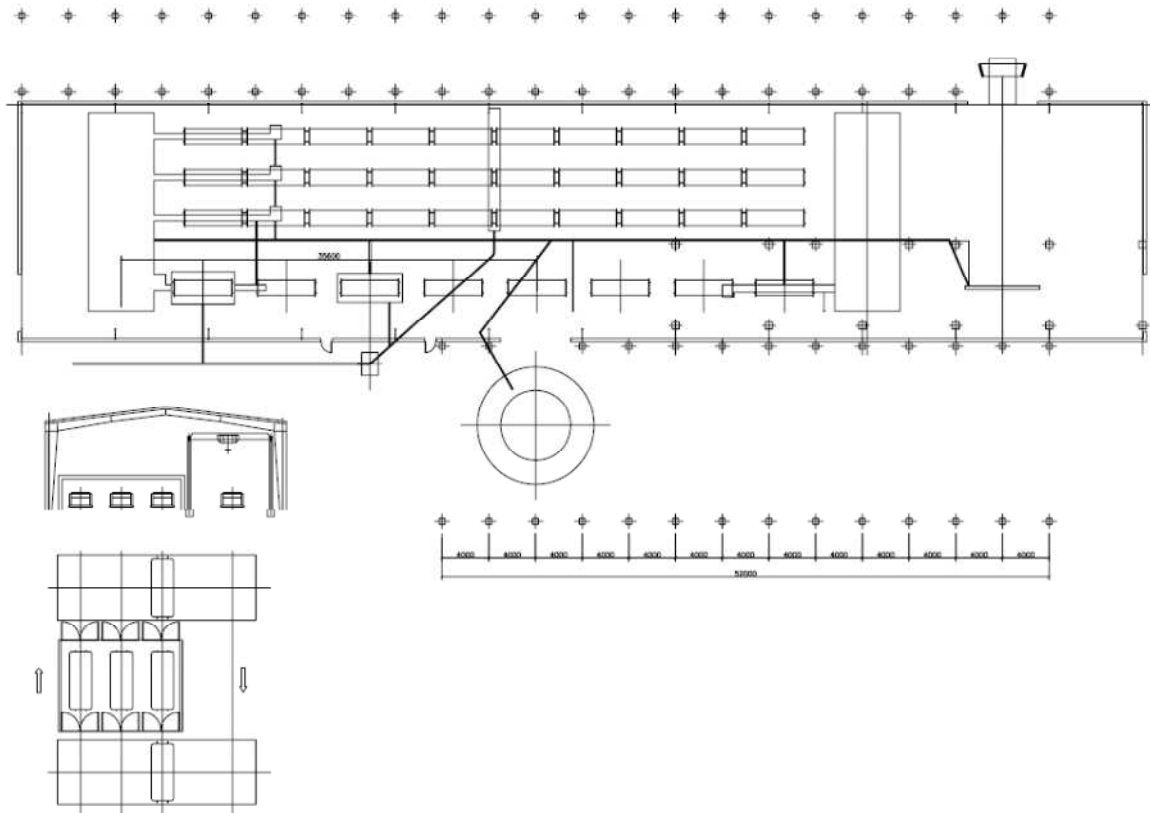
Vista de la planta y alzado de una fabrica de dovelas
